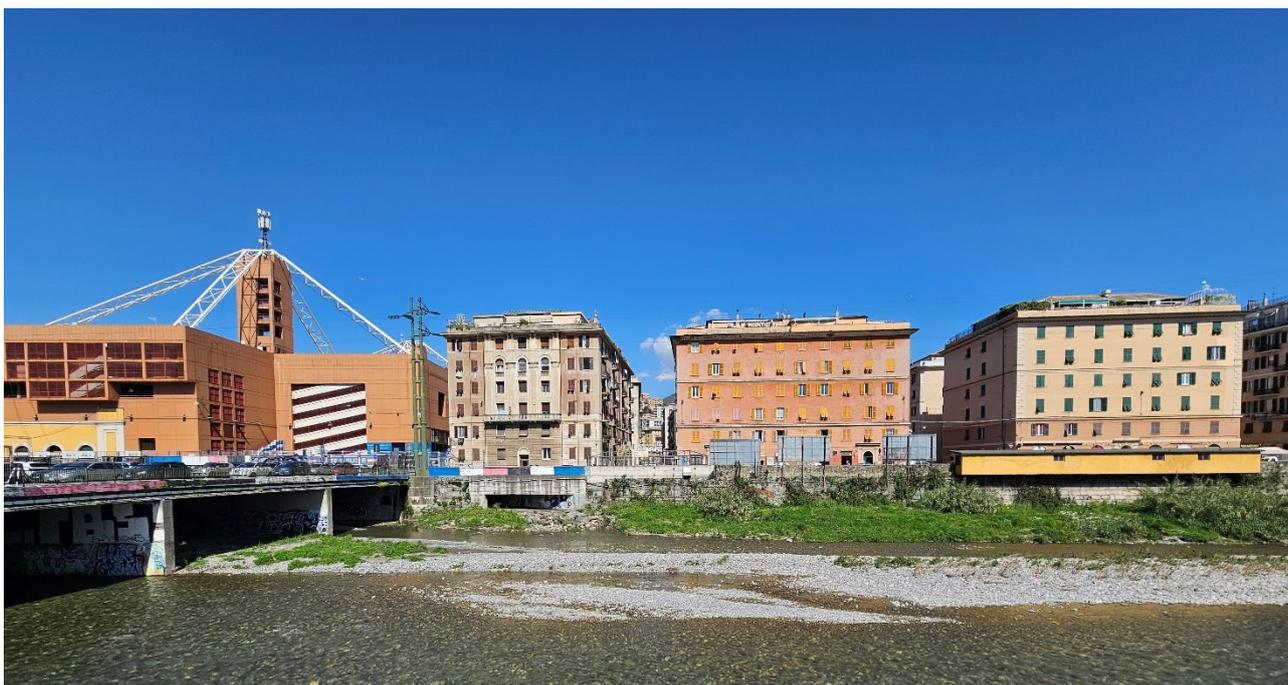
Piastra Studio e argine sponda sinistra con opere d'arte in cemento armato
